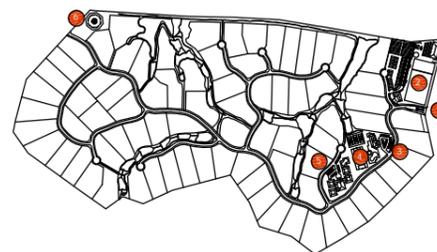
(Rev 01) - Planta do futuro Aldeamento Turístico
